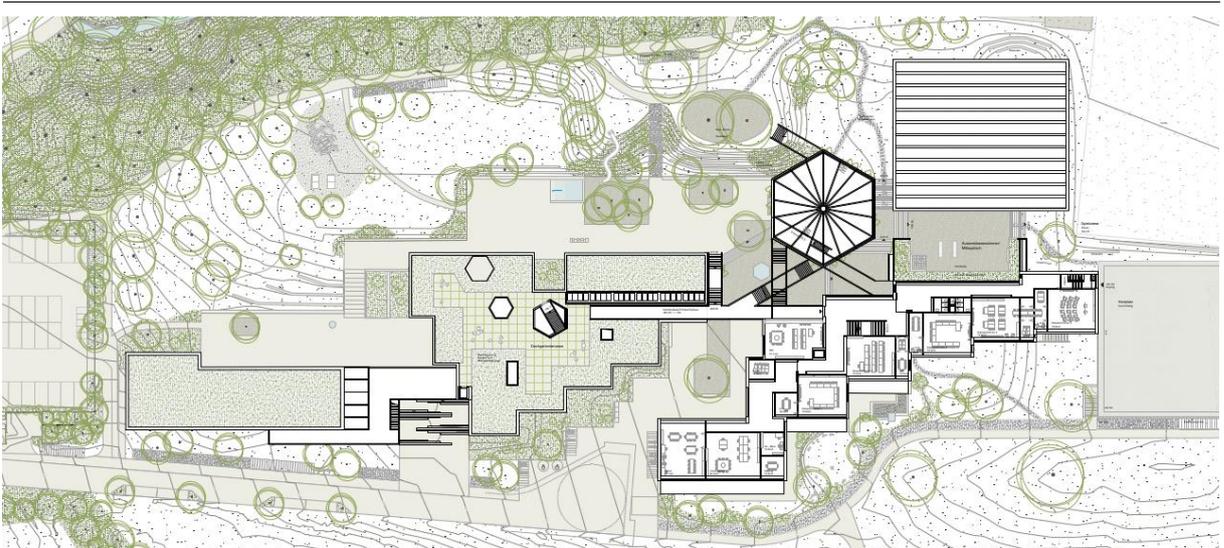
Grundrisse Dachaufbau Primarschule / 1. Obergeschoss Sekundarschule
